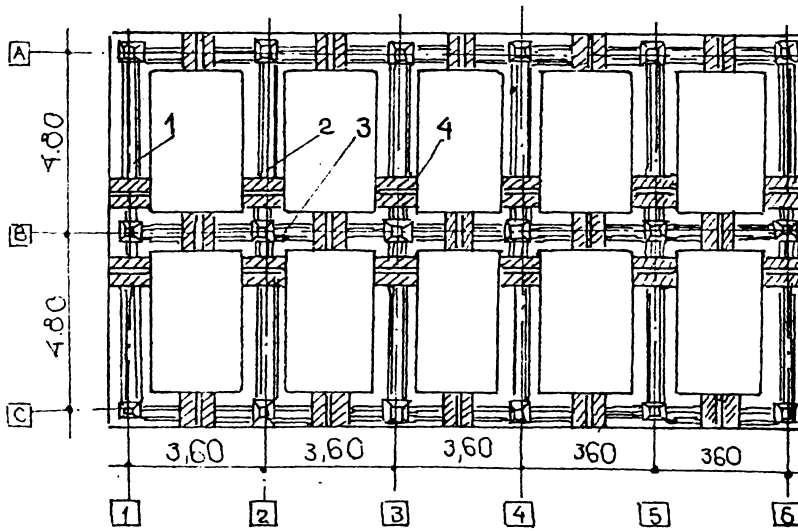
Planul de montaj al elementelor prefabricate pentru tălpi: 1-element L; 2-element T; 3-element X; 4-îmbinare.
